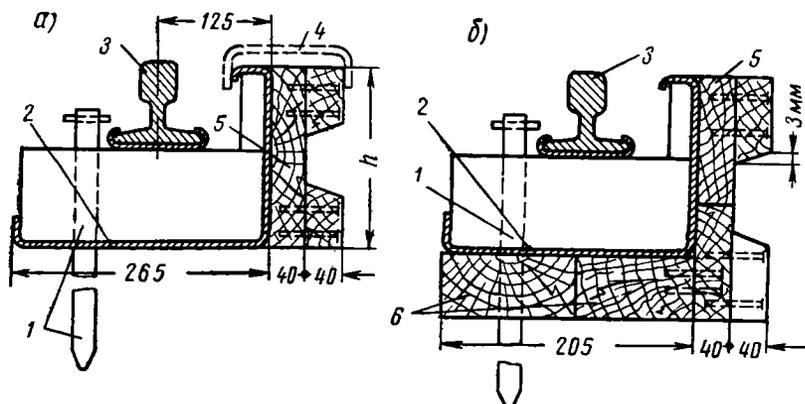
Конструкция рельс-форм и приставная шпунтовая опалубка: а — при устройстве новых покрытий толщиной 20 см; б — при устройстве покрытий толщиной более 20 см (установка рельс-форм на деревянных брусках);
